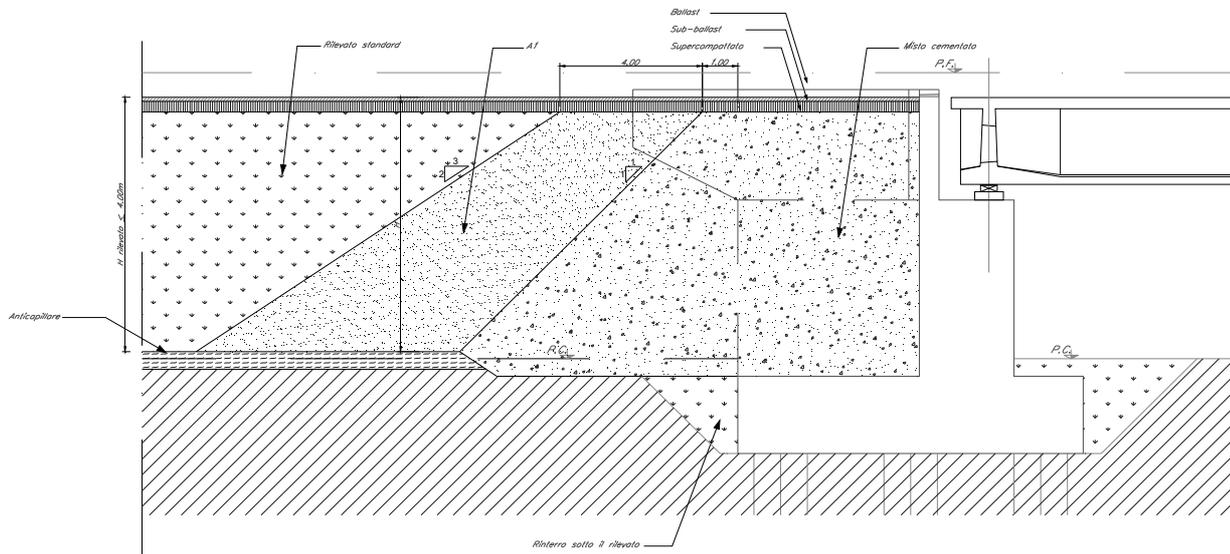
Zona di transizione rilevato – spalla viadotto/ponte con $H \leq 4,00$ m
